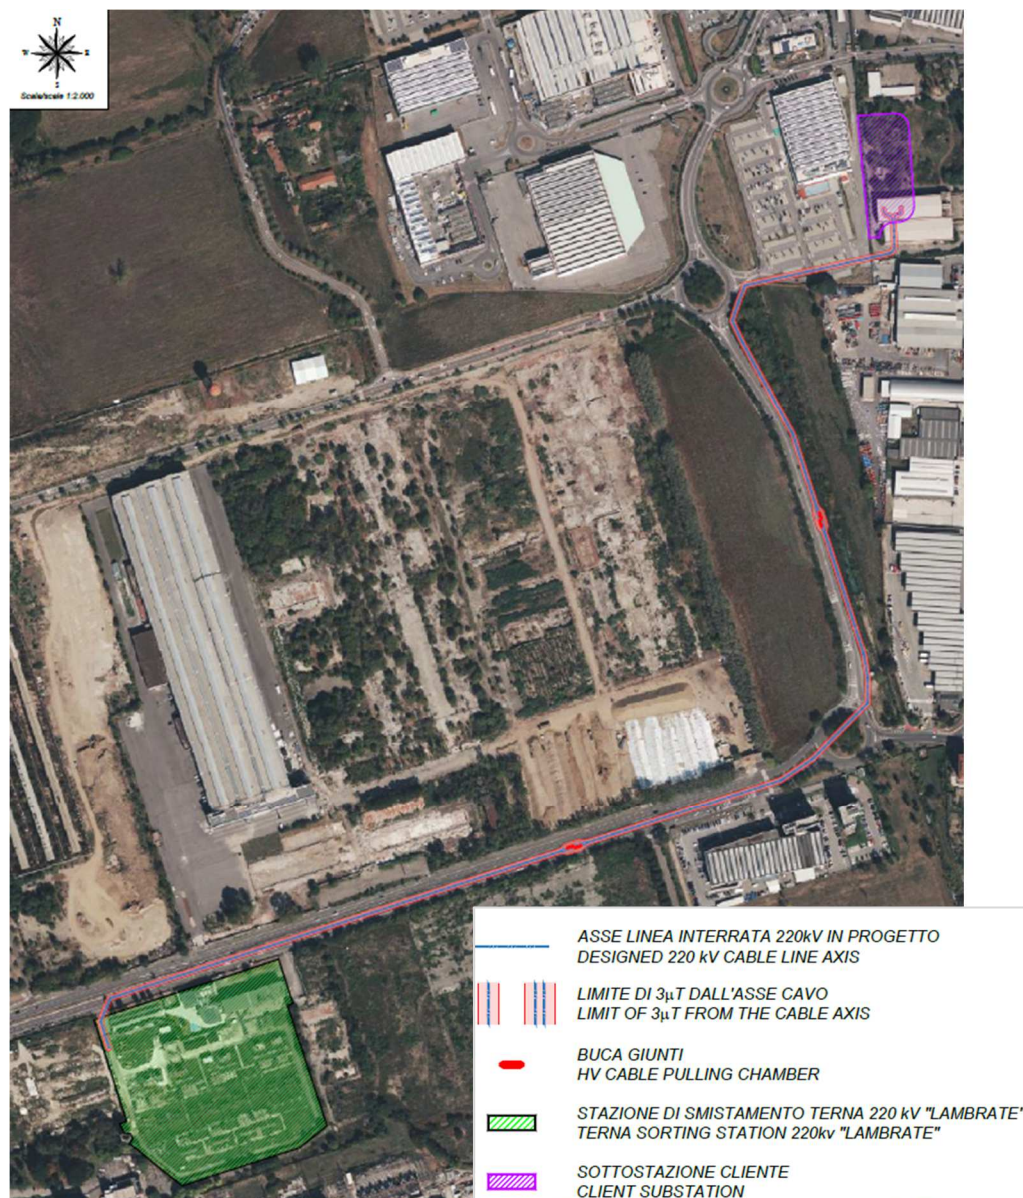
Planimetria della linea di connessione elettrica in alta tensione
